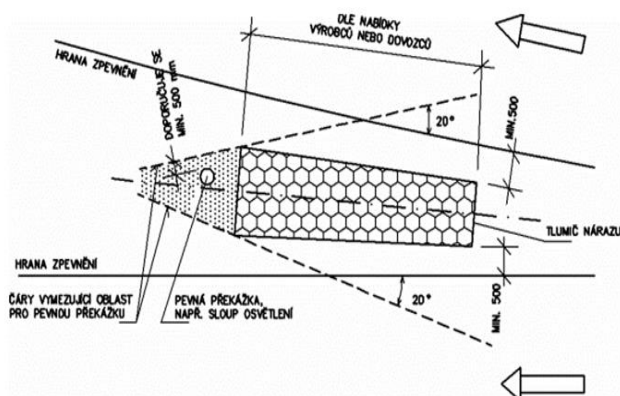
Příklad půdorysného umístění tlumiče nárazu. [1]
